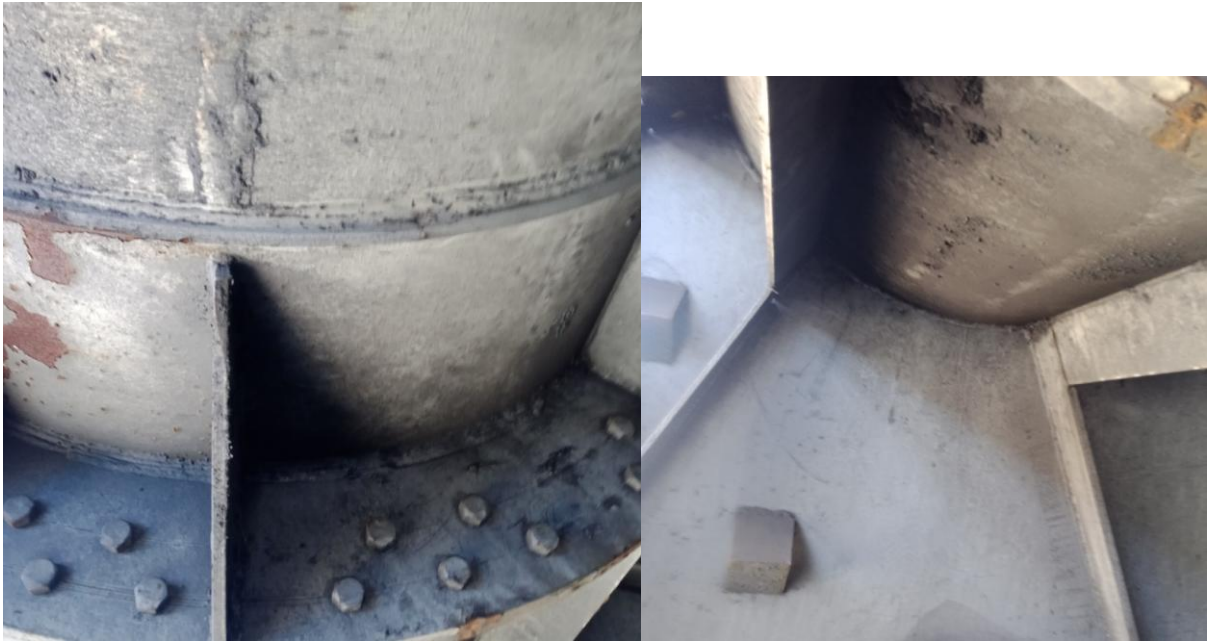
Сварные швы и болтовые соединения центрального вала
